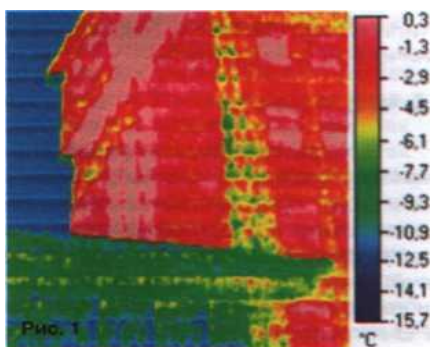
Сопоставление теплотехнического состояния зданий. На переднем плане здание, у которого устроен вентилируемый фасад. На заднем плане обычное панельное здание со значительными теплопотерями через ограждающие конструкции — температура наружных стен примерно в три раза выше.
